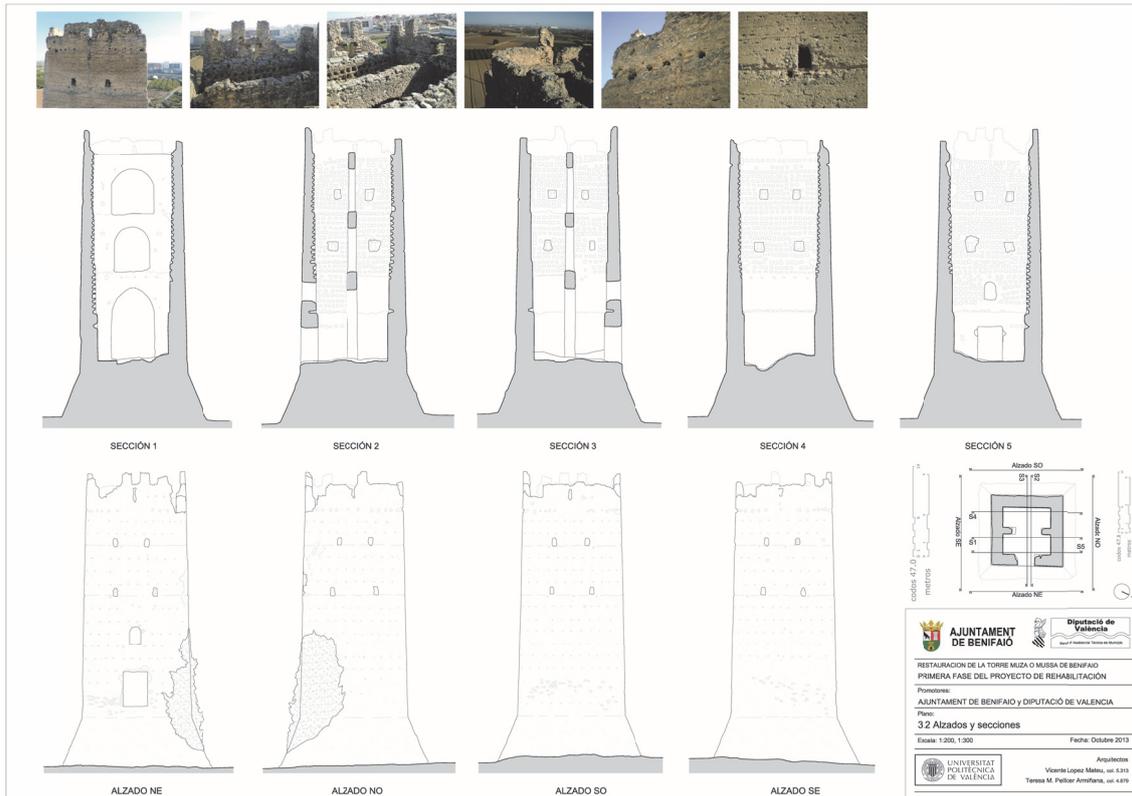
Planos de planta y sección del estado inicial de la torre cuando se realizaron los estudios previos.
